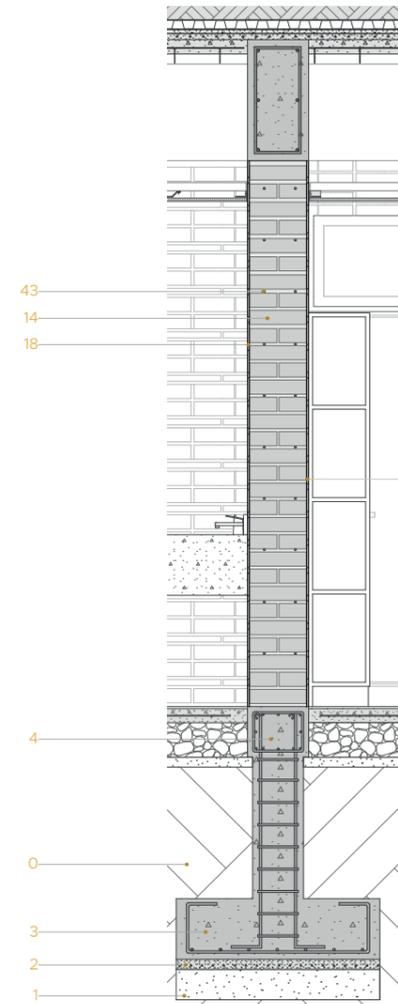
\_C4: sección constructiva\_07, muro portante, sala de tanatopraxia
